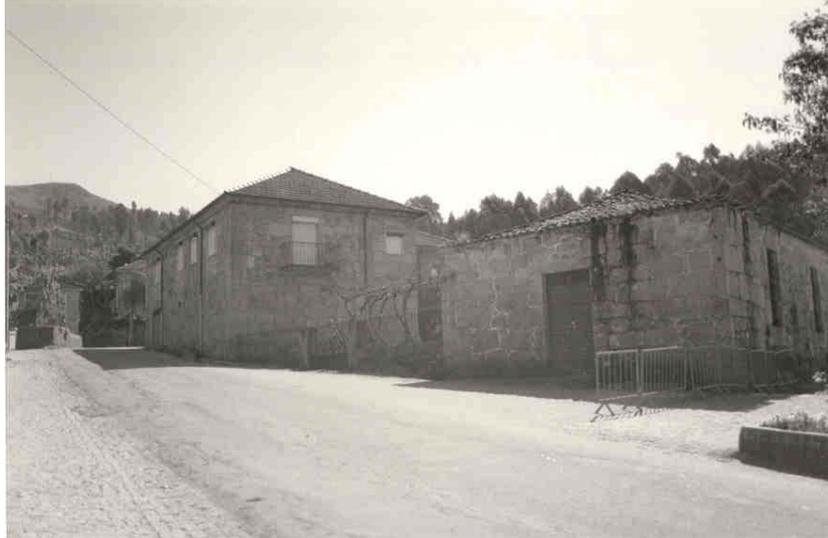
Implantação da residência paroquial de Souto (Santa Maria)
